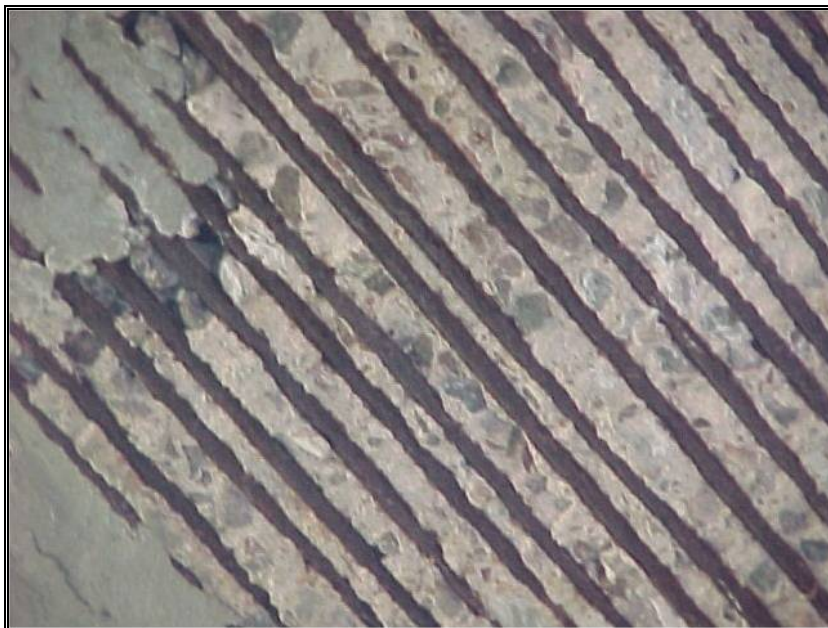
Face inferior de laje em balanço sem pingadeira: Concreto deteriorado e armaduras aparentes com corrosão
